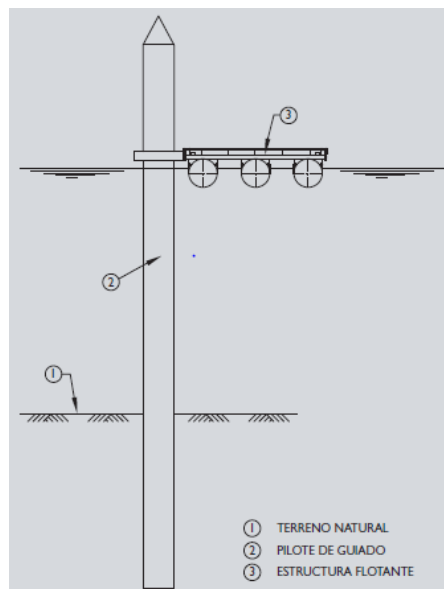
Pantalan con pilote guiado. Fuente: ROM 2.0-11
